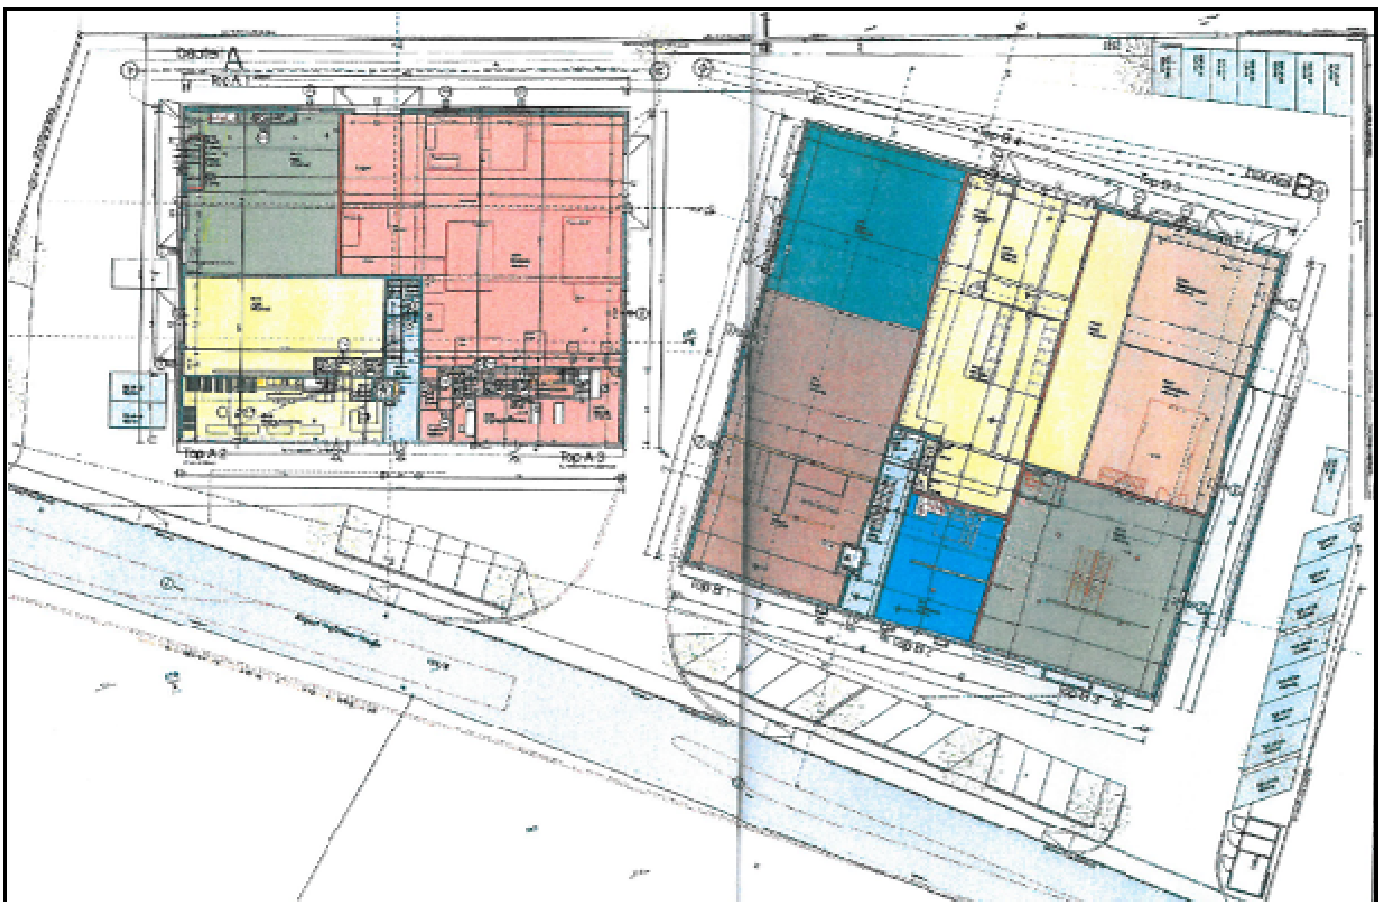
Lageplan Gebäude mit WE-Objekten¹⁰
